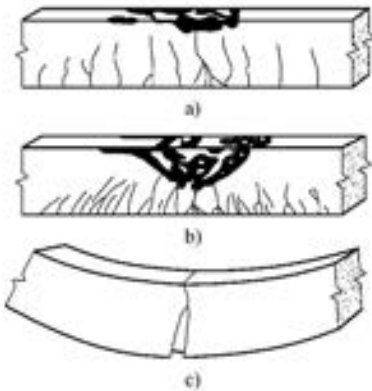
不同配筋率钢筋混凝土梁正截面破坏形态
